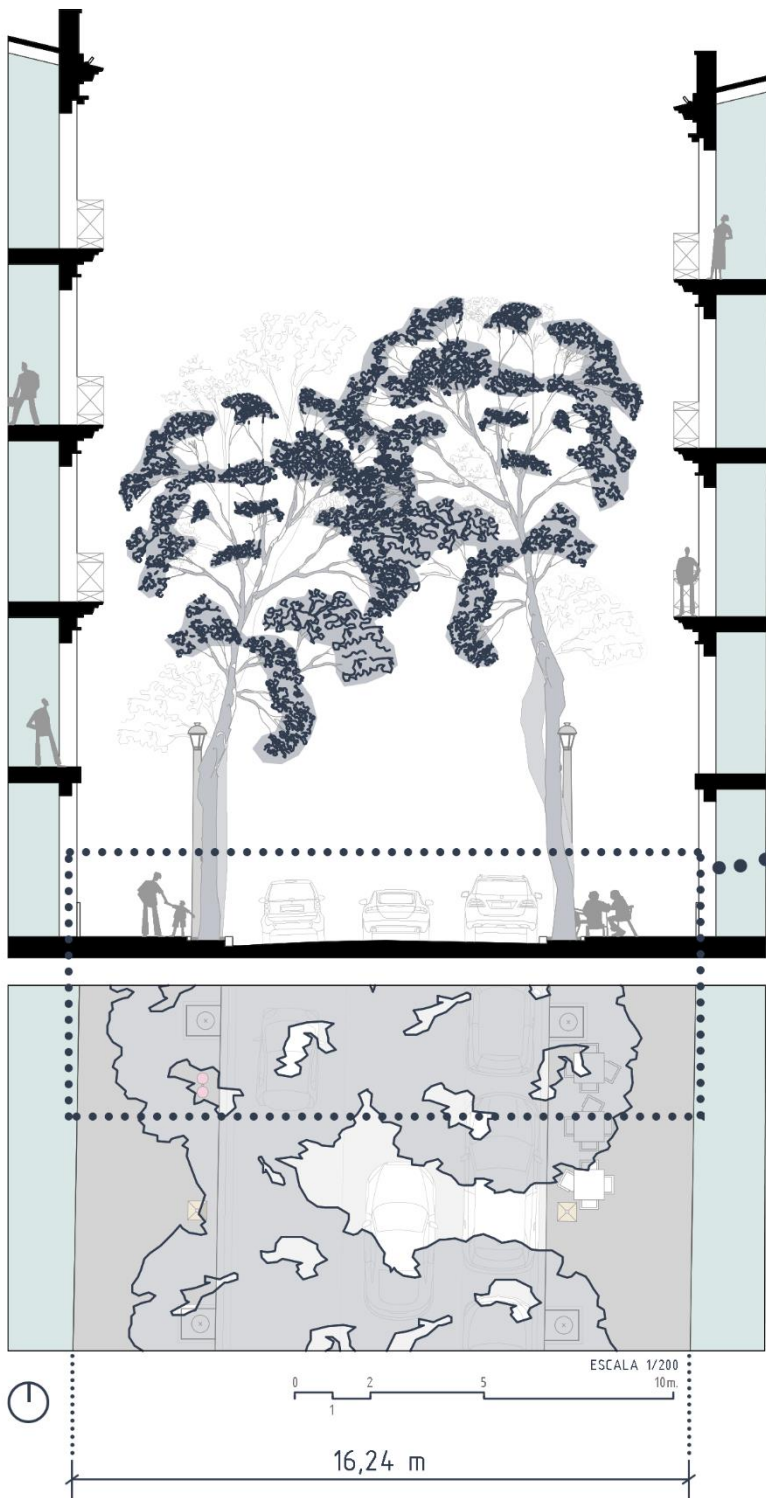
Plano de elaboración propia de ZOOM E 1/150 m.
